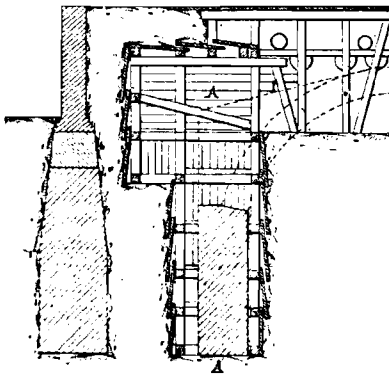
Demi-coupe transversale montrant la troisième phase de la construction. Boisage des fouilles et construction des piédroits de la voûte.
